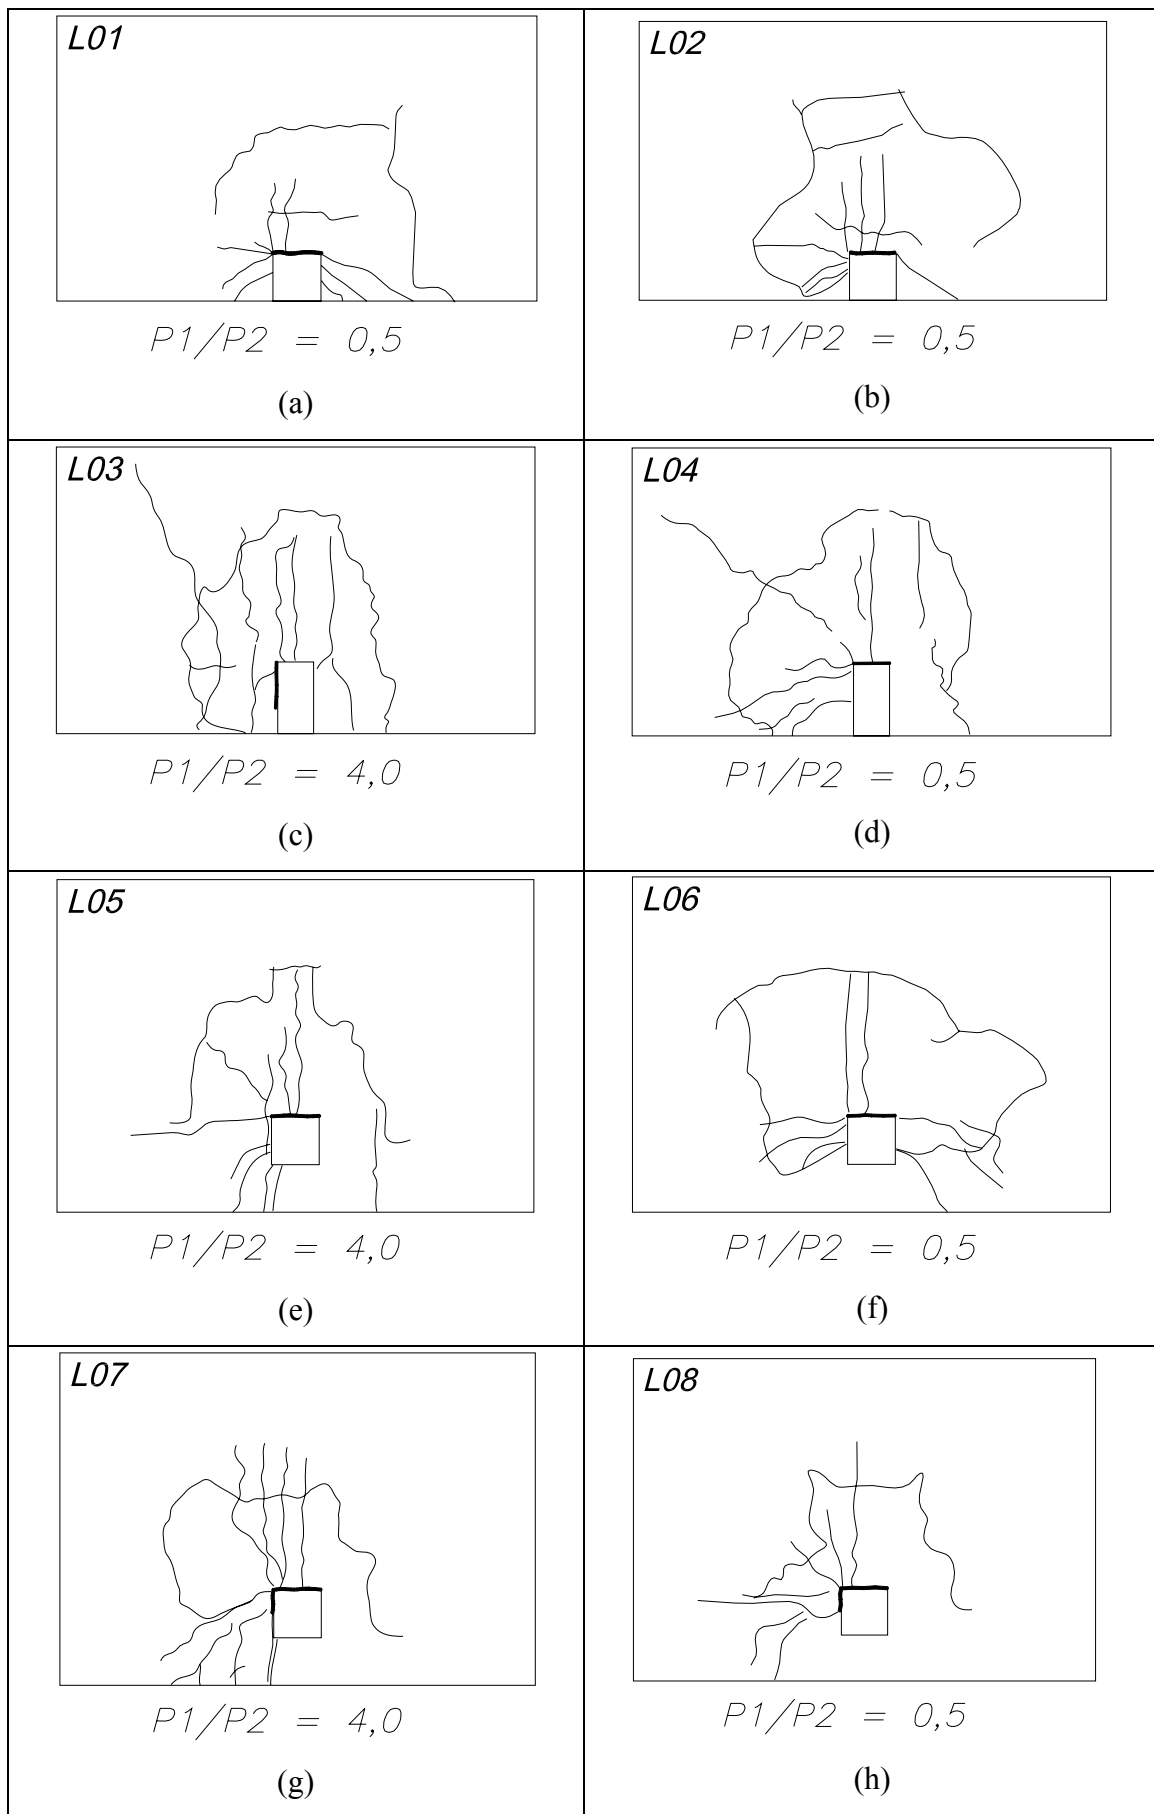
Mapa de fissuração das lajes dos modelos da primeira série de ensaios.
